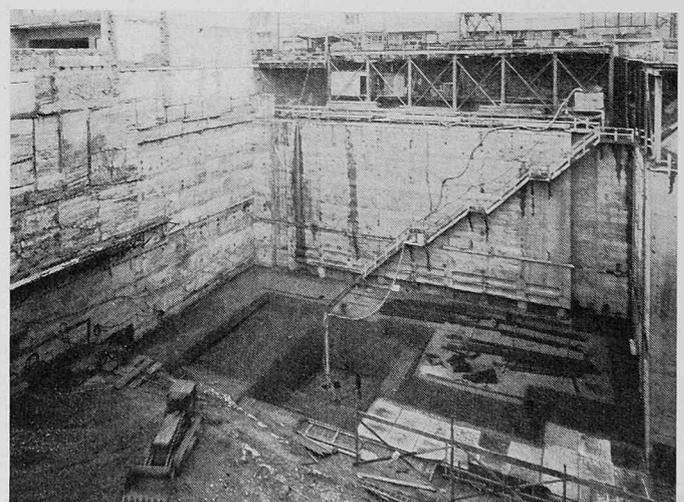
Neubau der TT-Direktion an der Wallstrasse in Basel: Baugrubenumschliessung mit einer aufgelösten Pfahlwand
